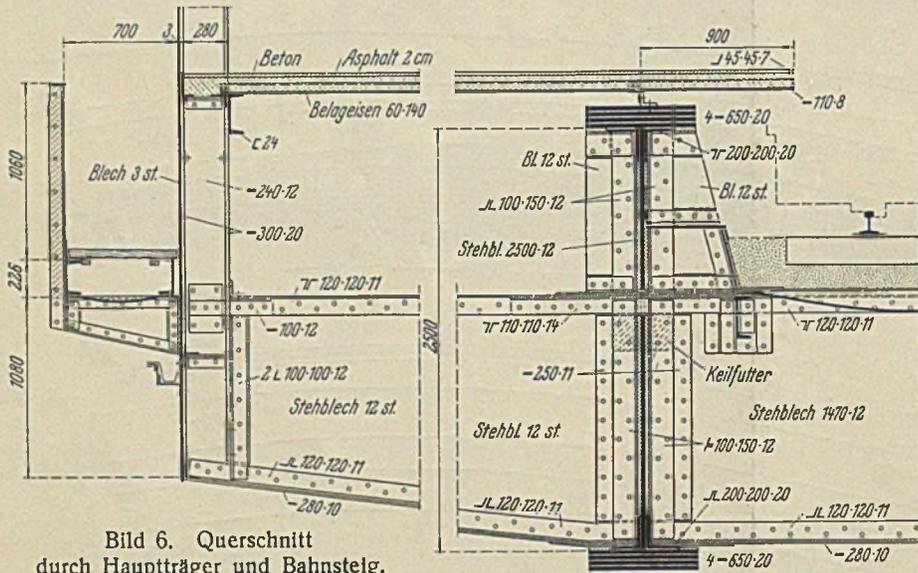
Querschnitt durch Hauptträger und Bahnsteig.
